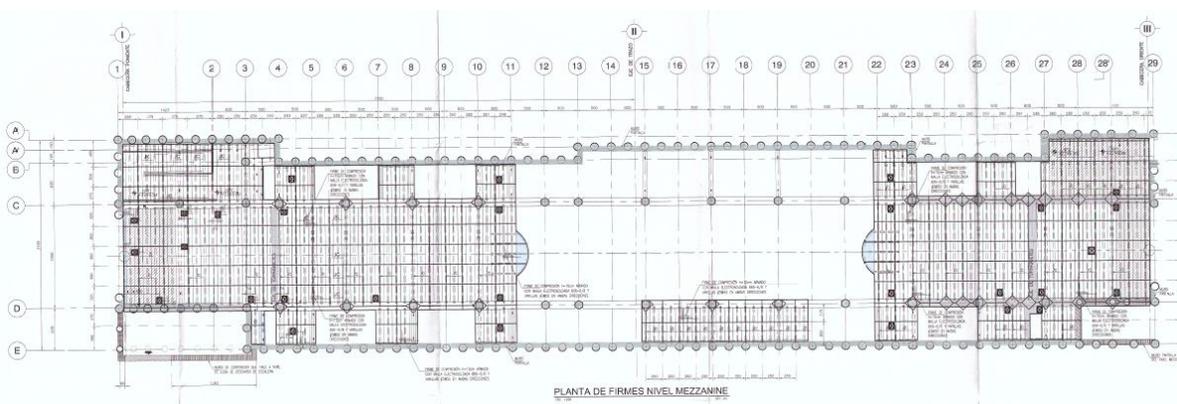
Planta de FIRMES Nivel Mezzanine.
